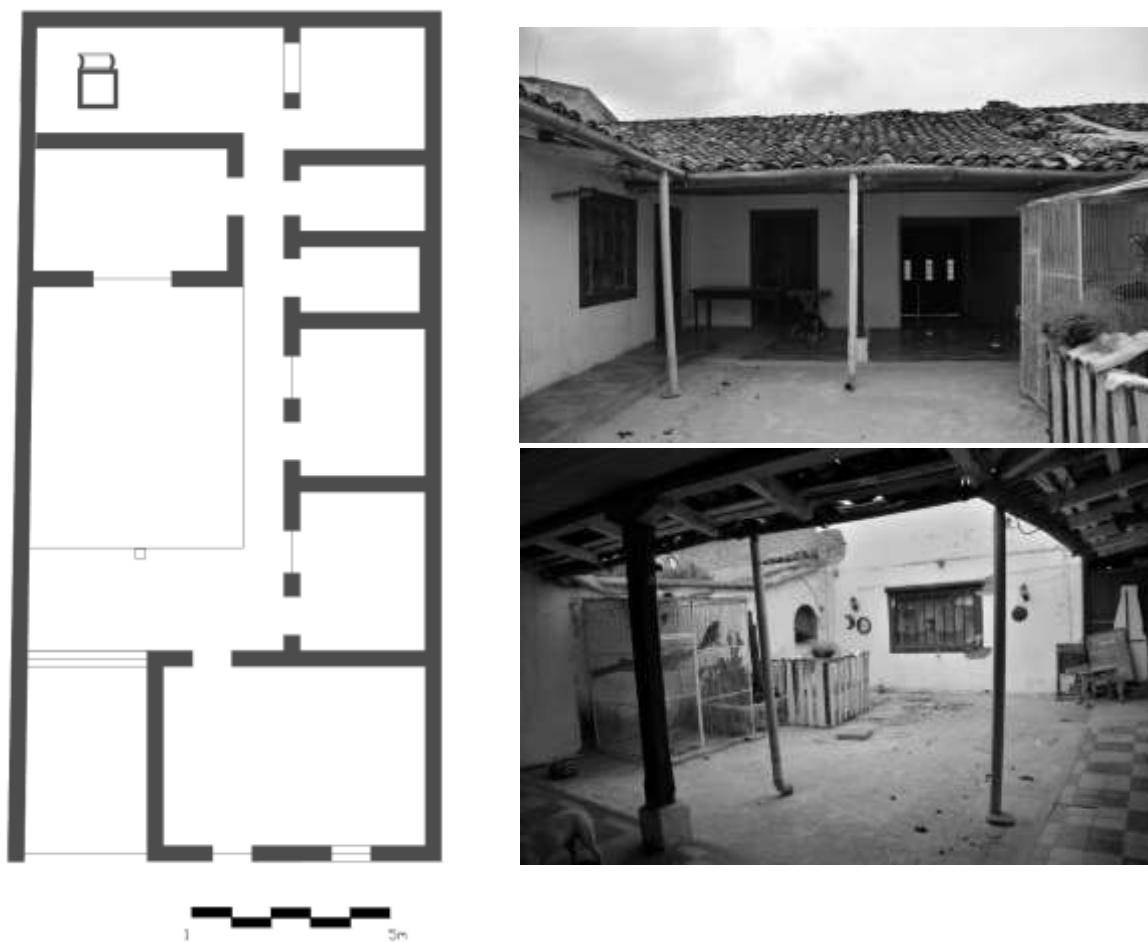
Democracia 007, Jalapa, Planta y fotografías del patio principal.
